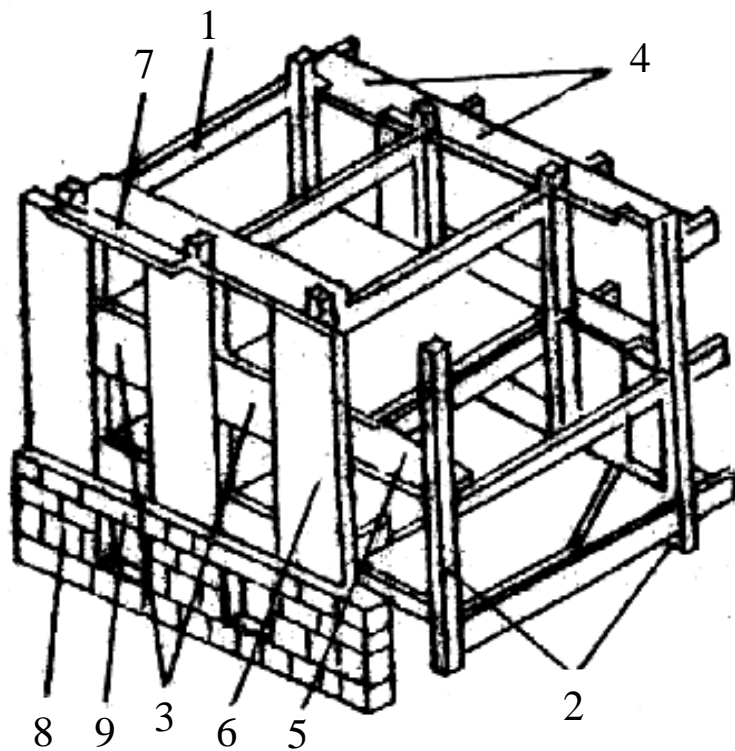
Схема безкаркасного великопанельного будинку:
